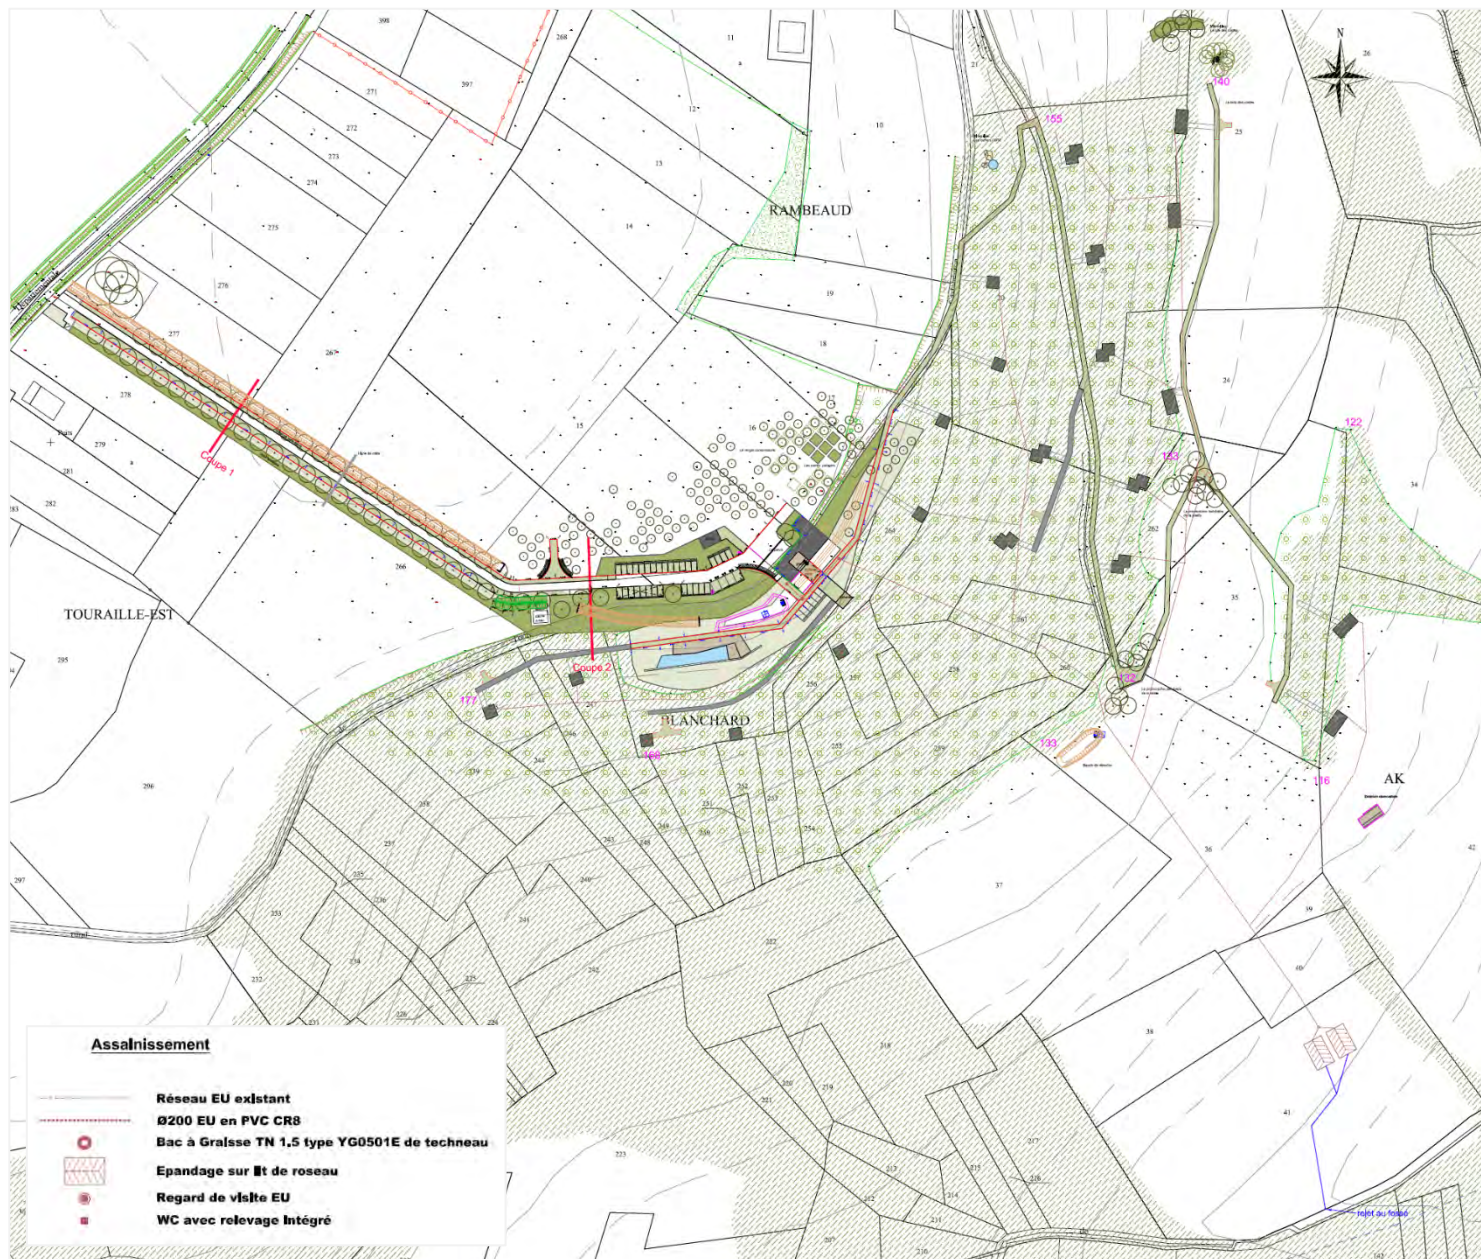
Plan de masse 1/1000 avec filière d'assainissement – Cf. Annexe 13 pour plus de détails
